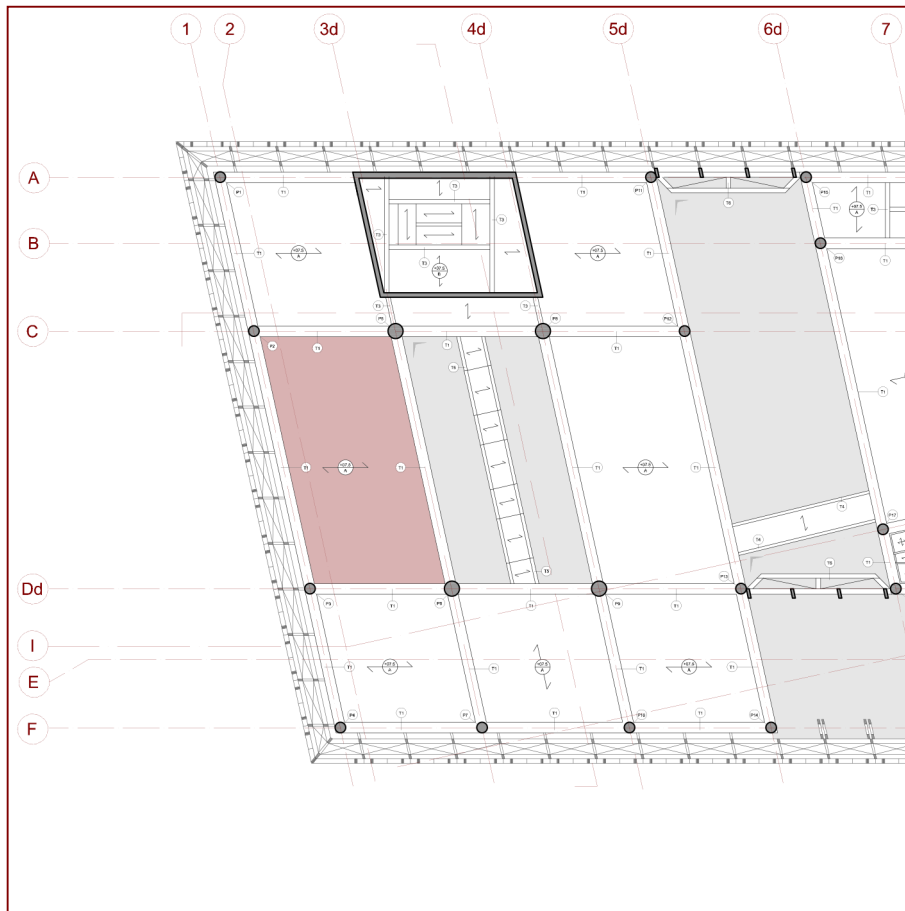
Posizione dell'area di calcolo - Collezione.
